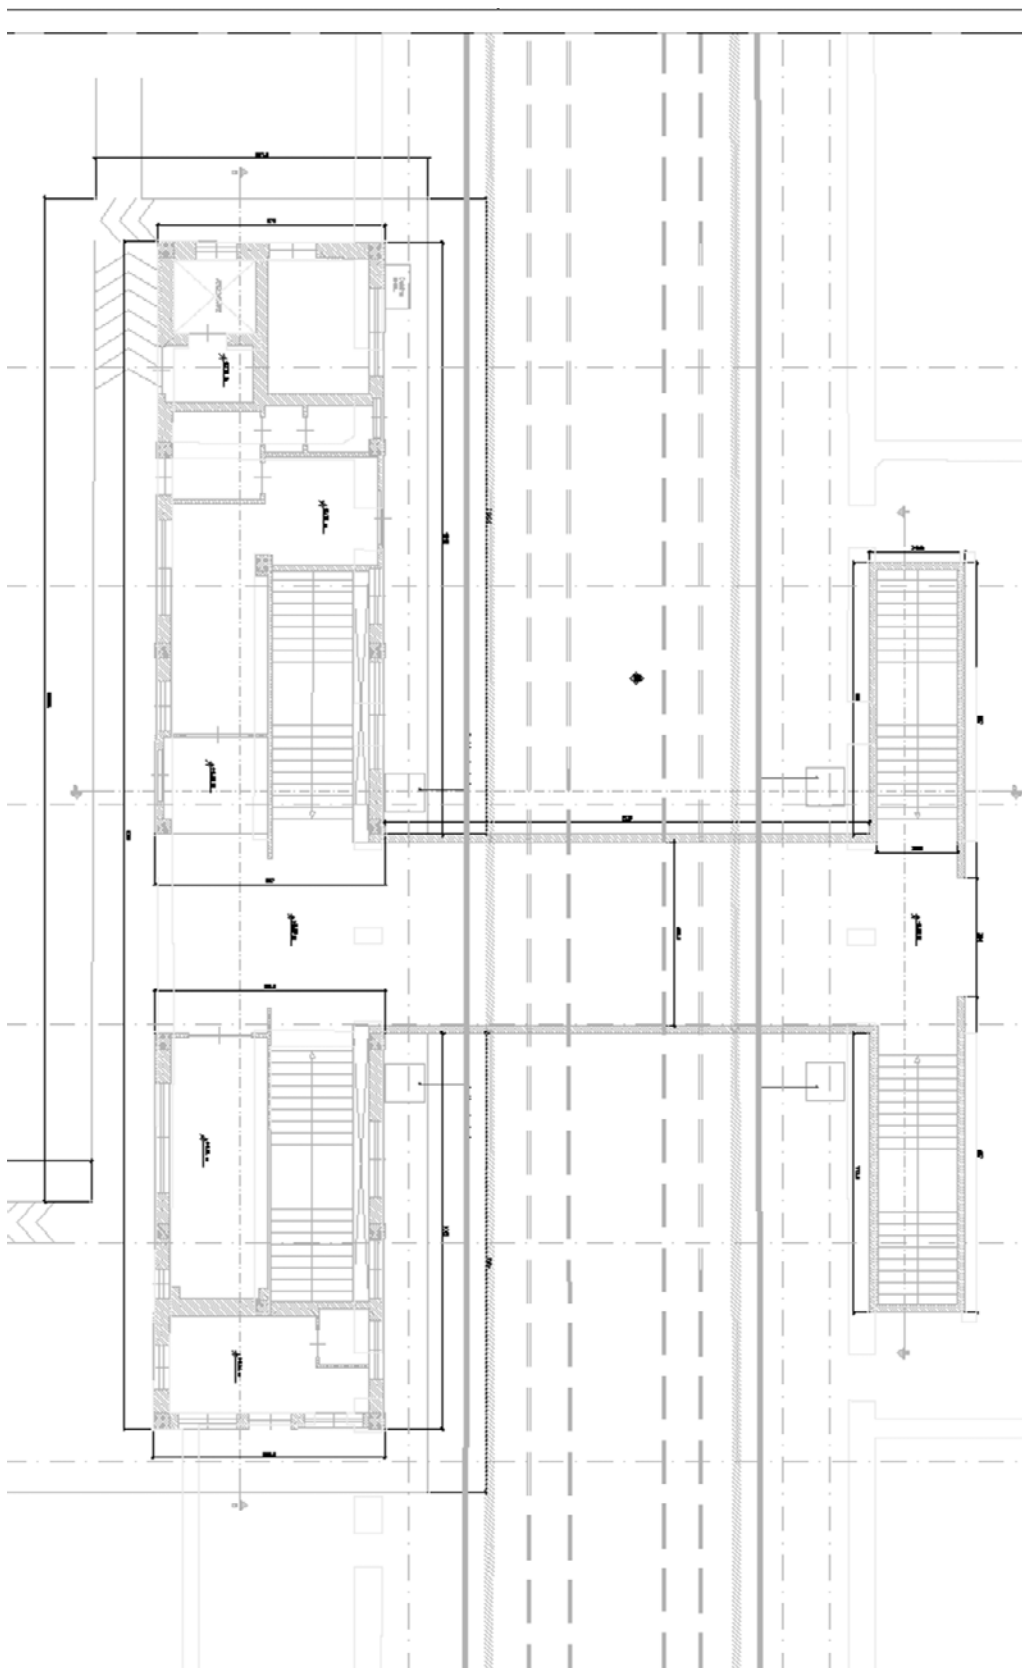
Pianta del fuori terra – Stato di fatto
